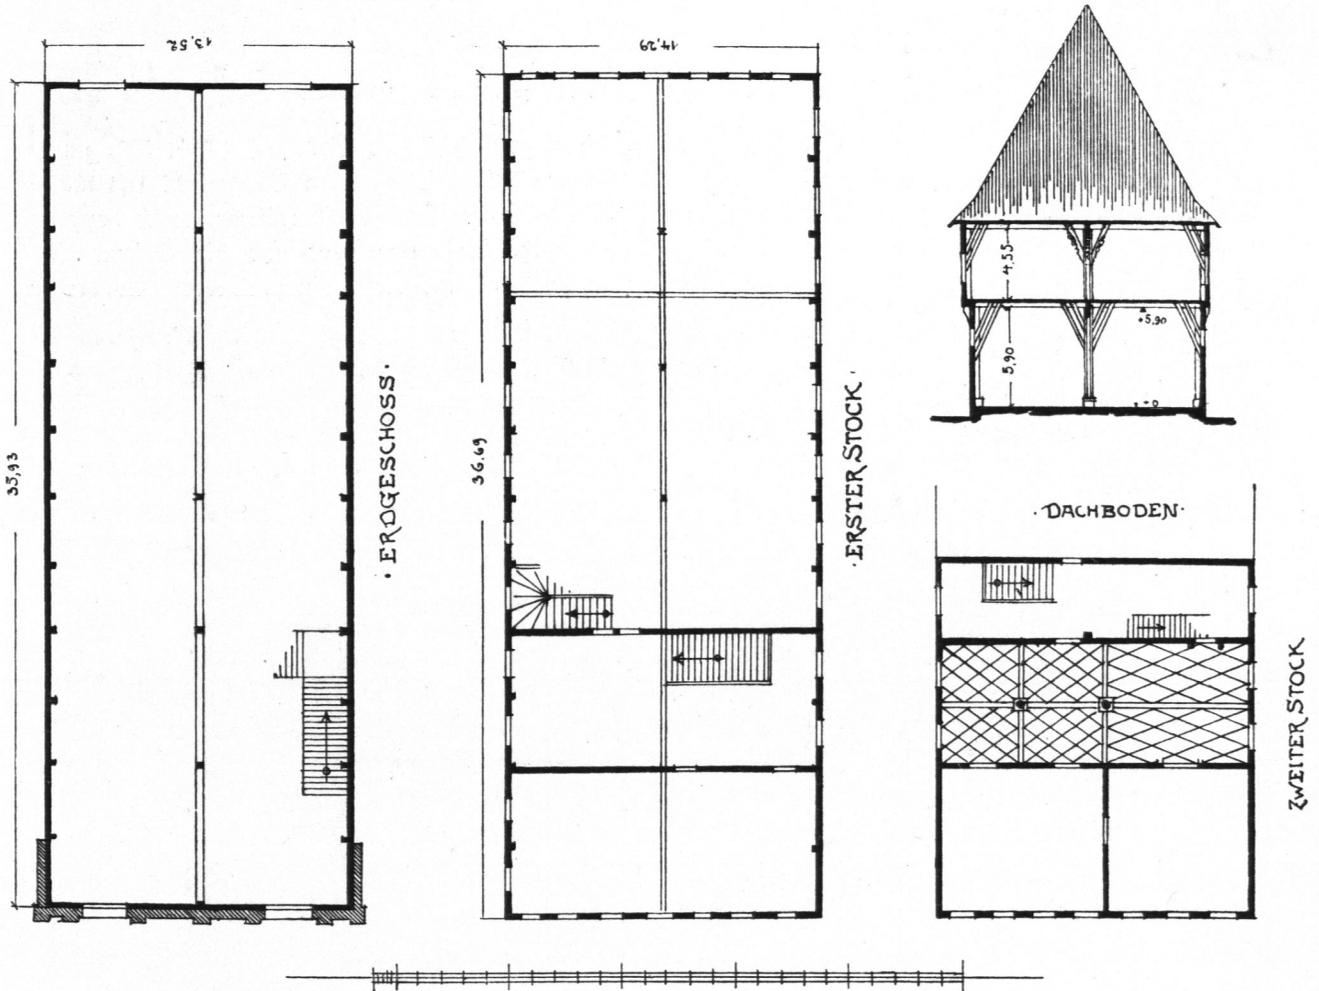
Rathaus zu Eßlingen. Grundrisse und Querschnitt des alten Baues.
